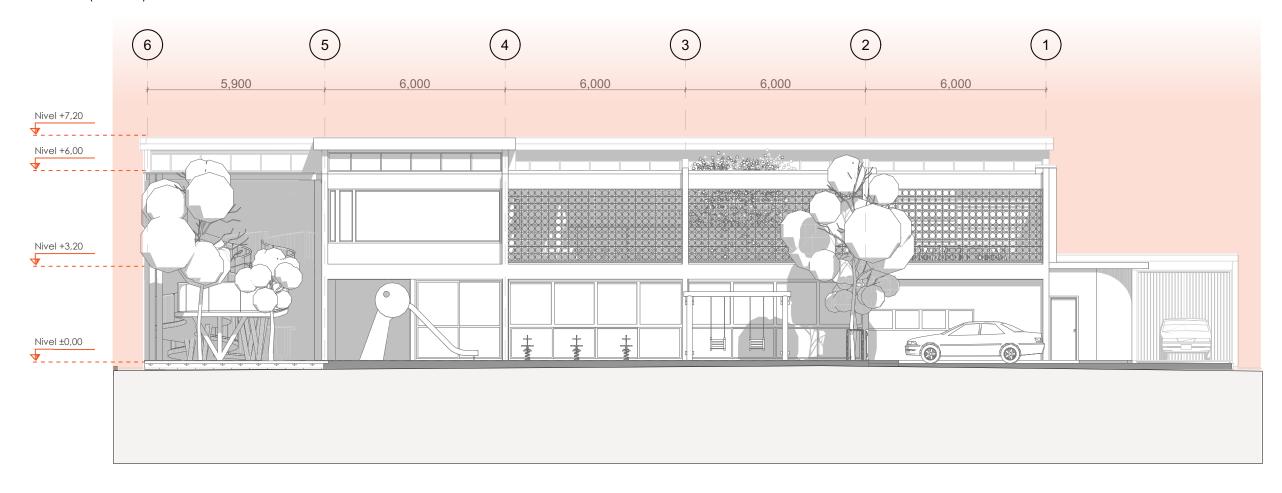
Fachada Este Fuente: Elaboración propia, 2025
